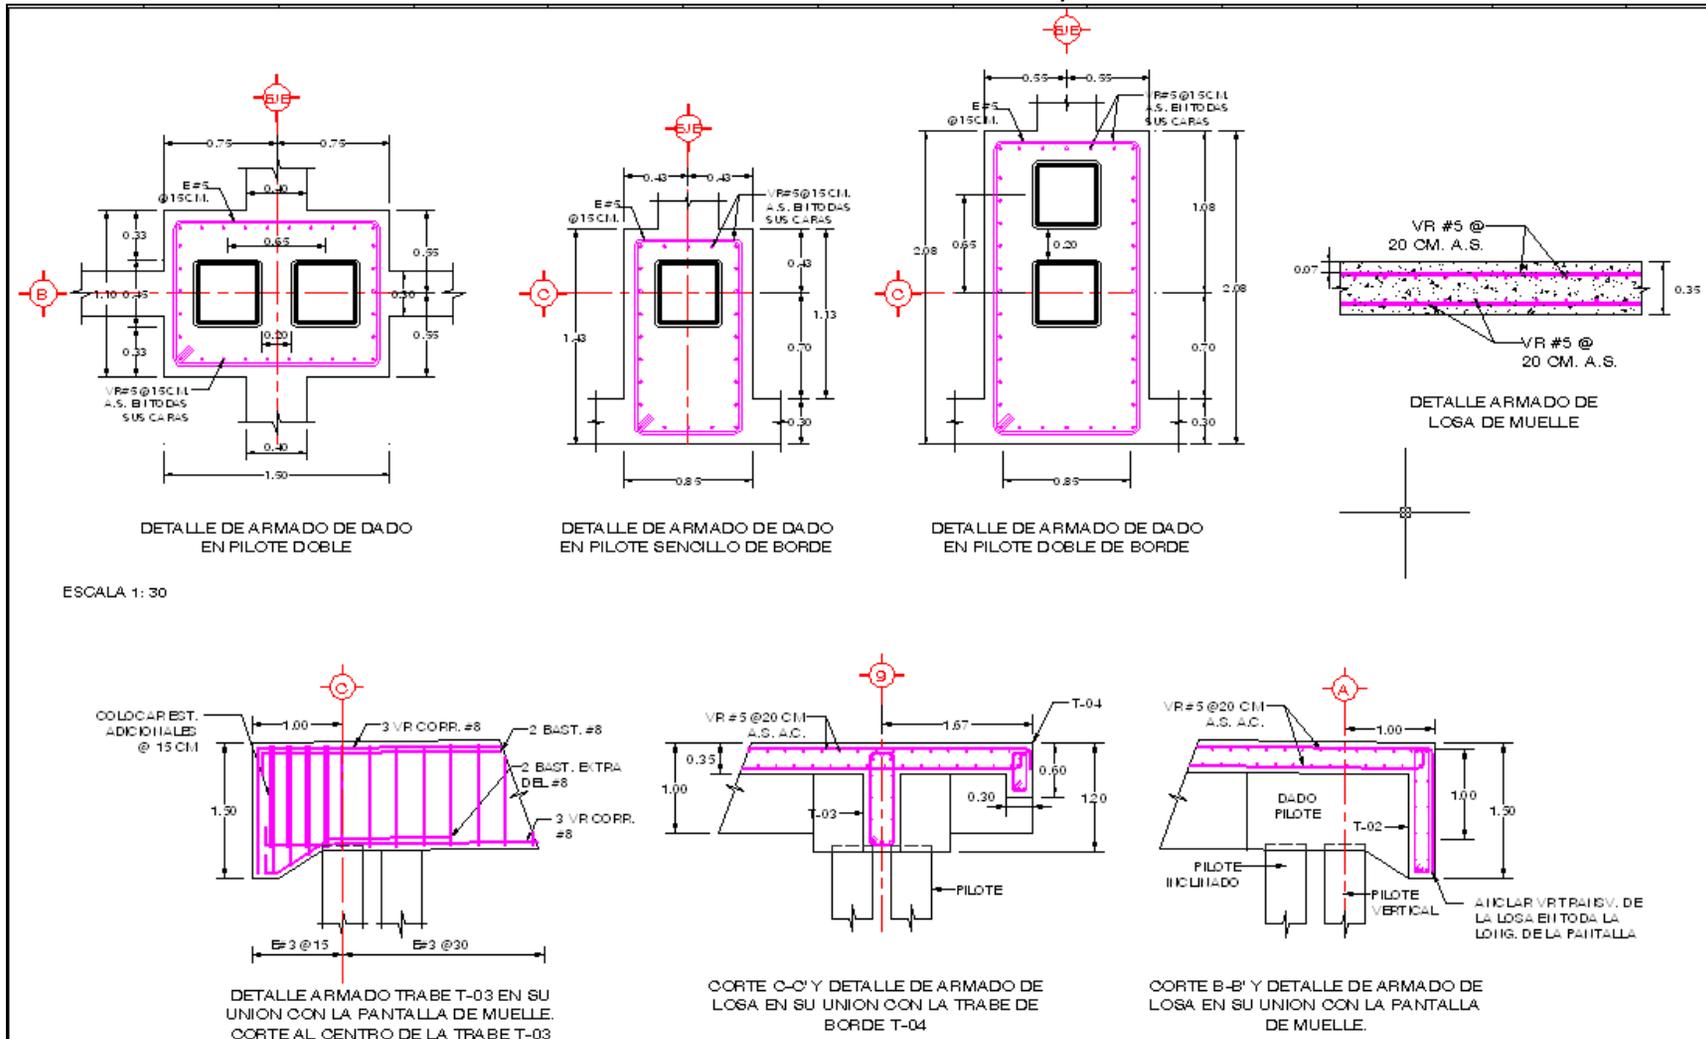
DETALLES DE ARMADO DE DADOS, TRABES Y LOZA
